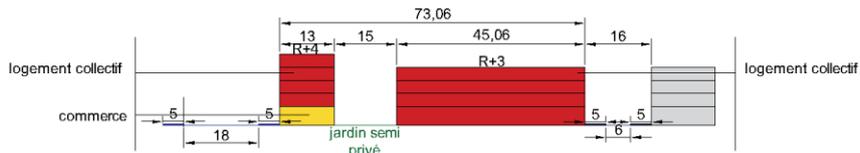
coupe des fonctions sur voie statut3. Fait par l'auteur
